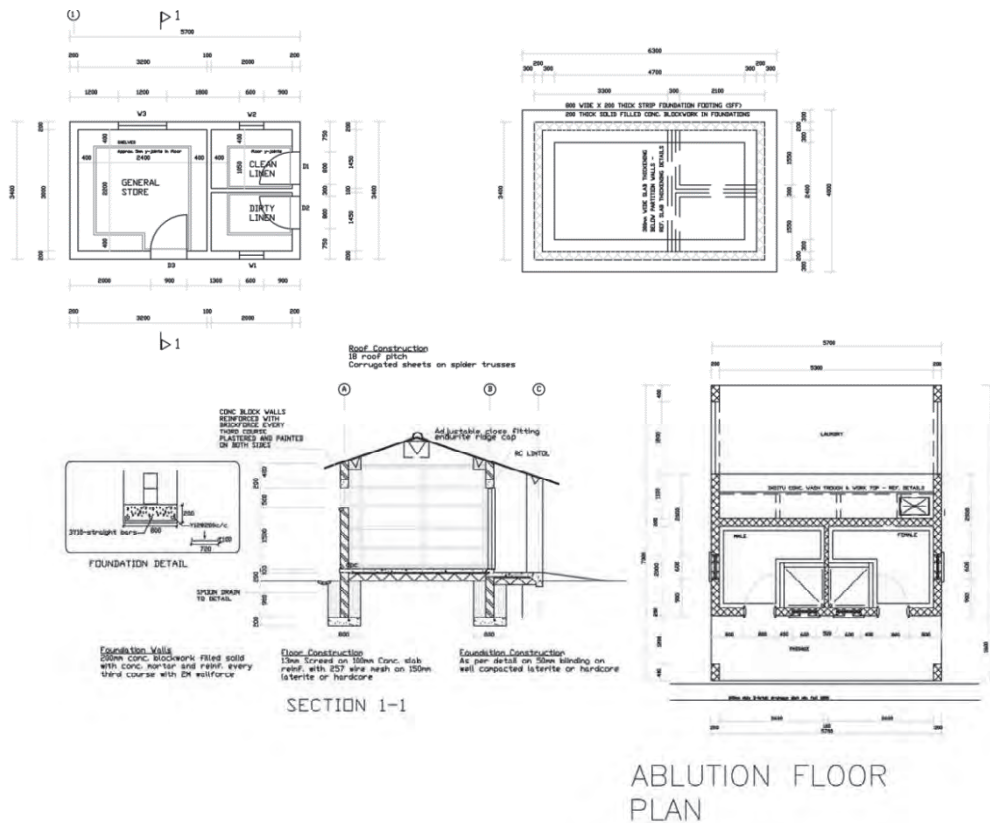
Health Centre 平面图 · 立面图 (STORES, LAUNDRY)
